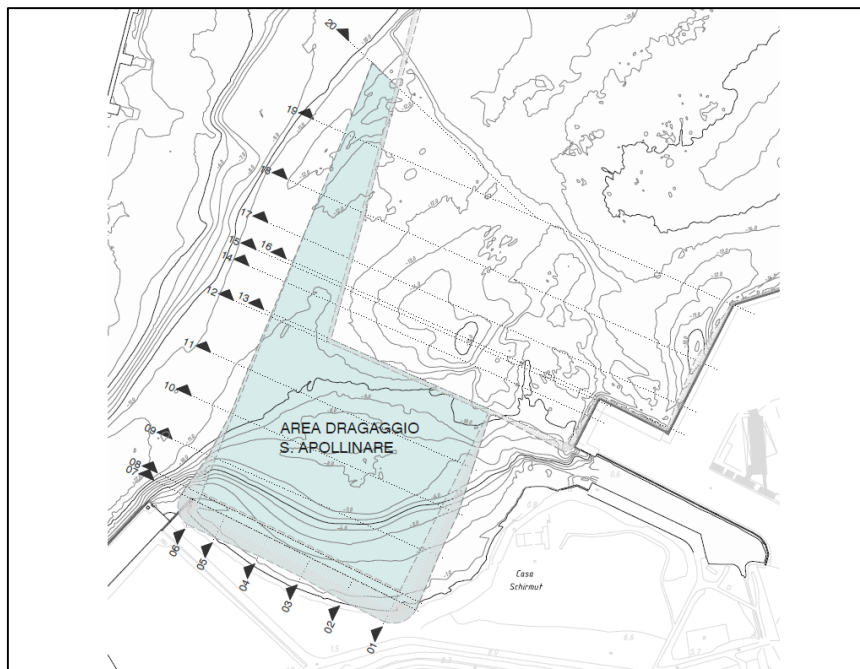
Planimetria di dragaggio Area S. Apollinare
